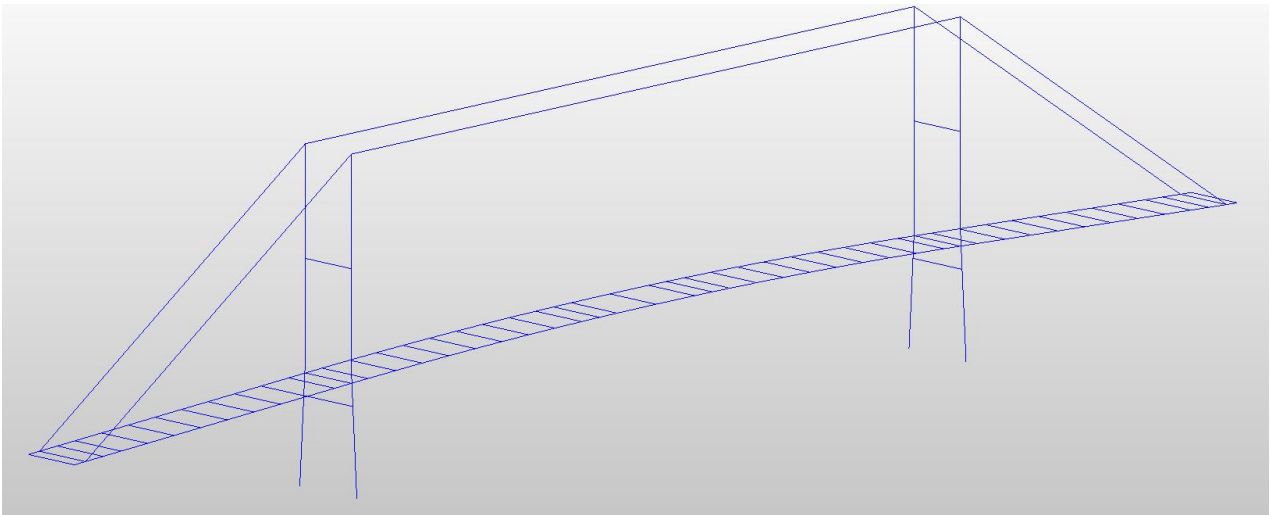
Geometría sistema de rigidización longitudinal 1 en estructuras atirantadas según 2 planos
